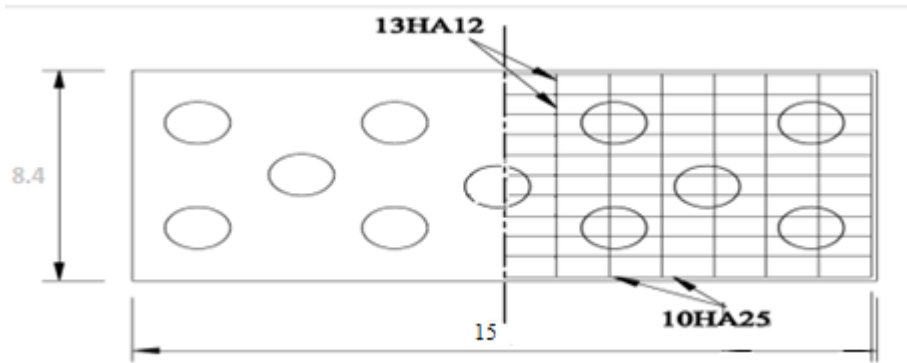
Ferrailage de la nappe supérieure de la semelle.
